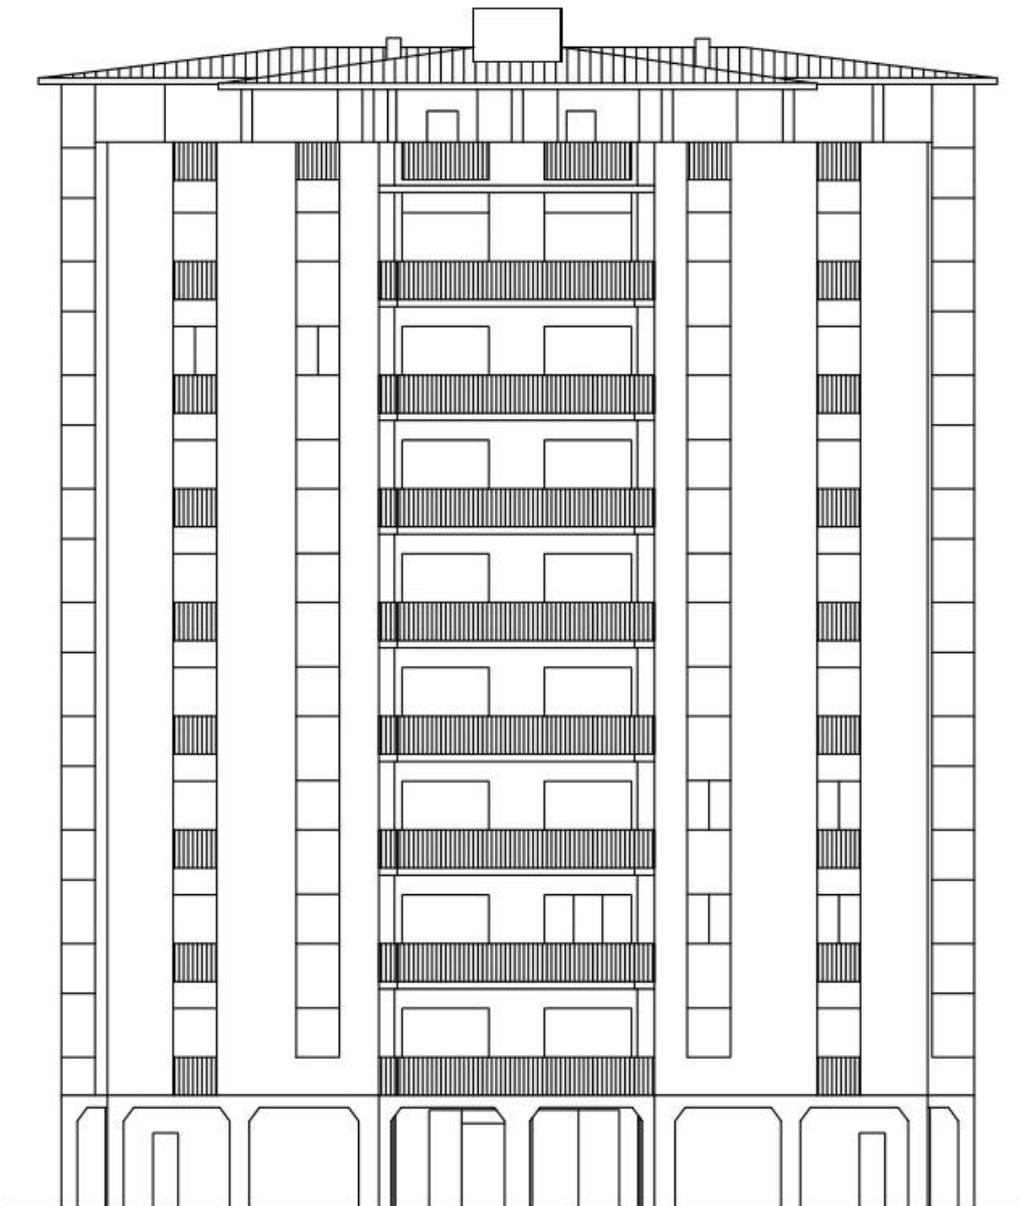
Prospetto Est, via Brofferio 1. Scala 1:200. Fonte: Ater Padova.
